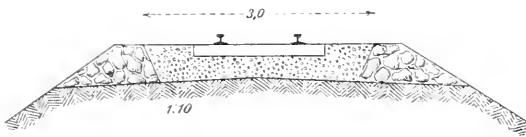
Kofferbettung mit Begrenzung durch Trockenmauern.
